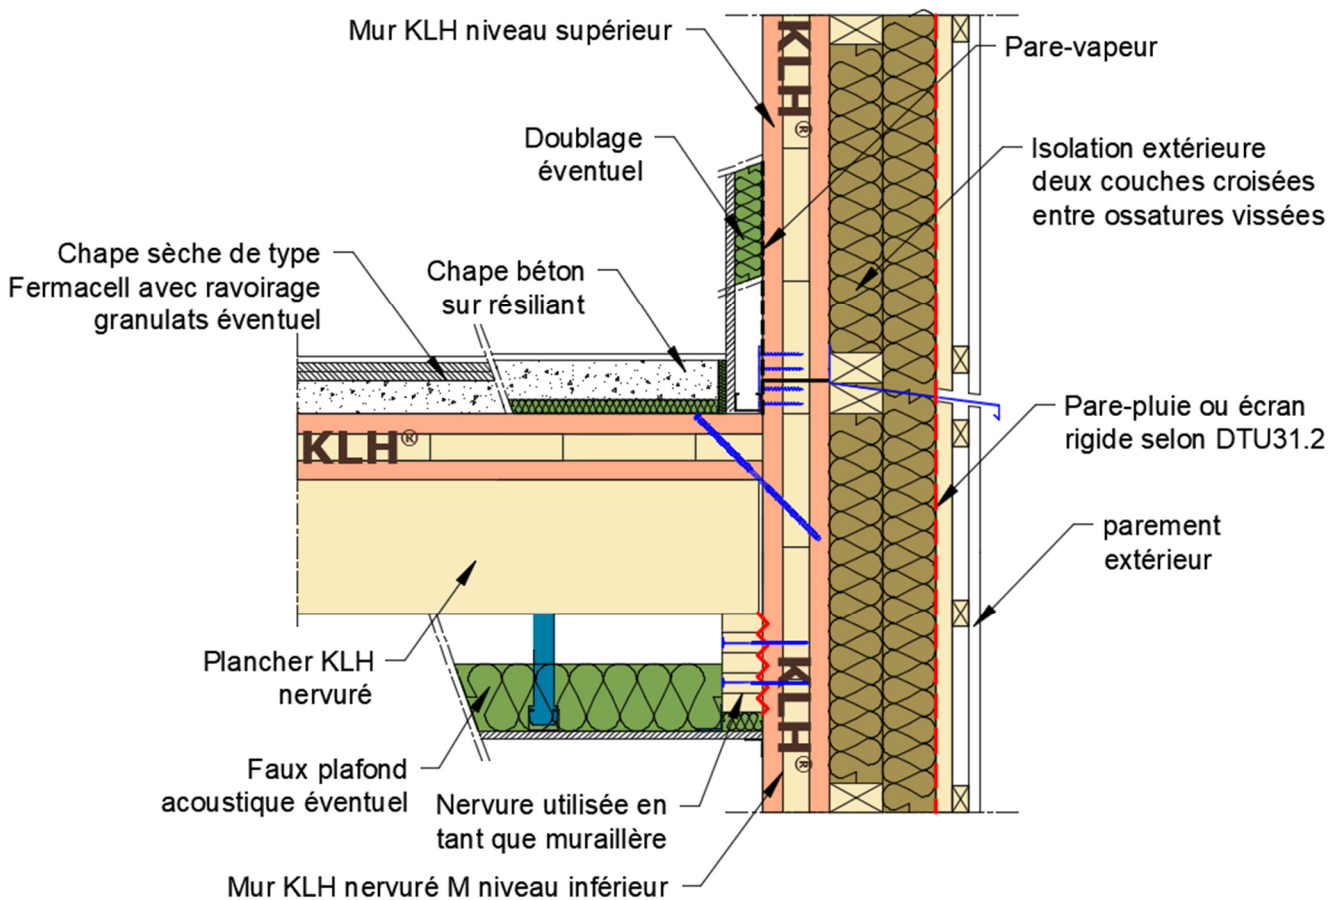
Exemple de coupe verticale plancher nervuré T reposant sur Mur extérieur KLH®-CLT nervuré T
